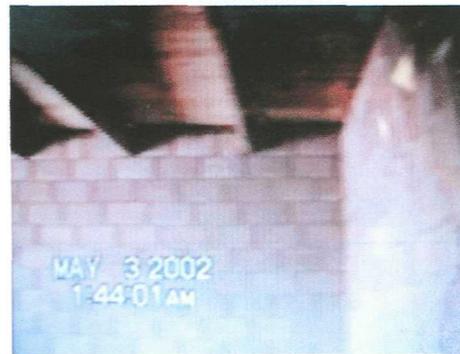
Techo tipo lagunero. Fuente: Video Hydraform, 2002
